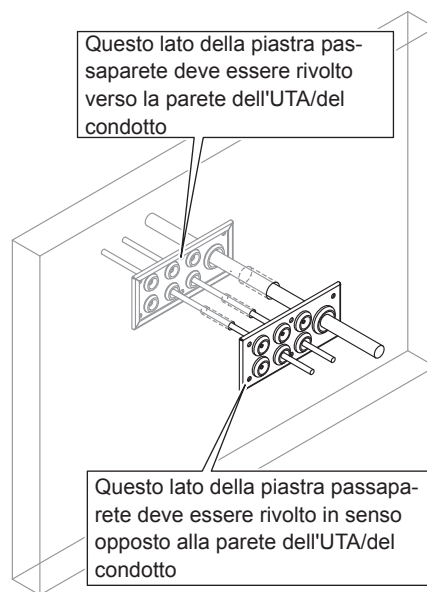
Montaggio della piastra passaparete (installazione interna)
